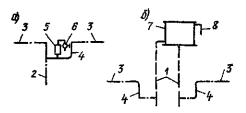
17. Схемы удаления воздушных скоплений из системы водяного отопления с нижней разводкой
